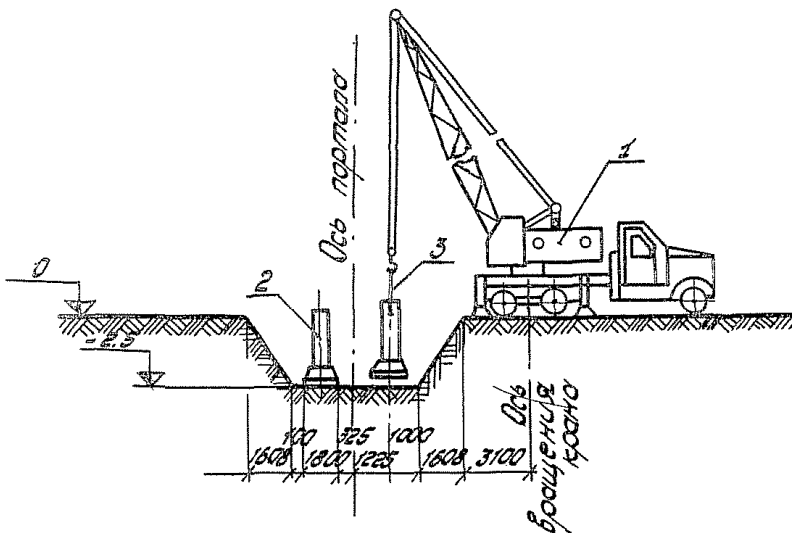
Разрез 2-2 на стадии монтажа фундаментов:
